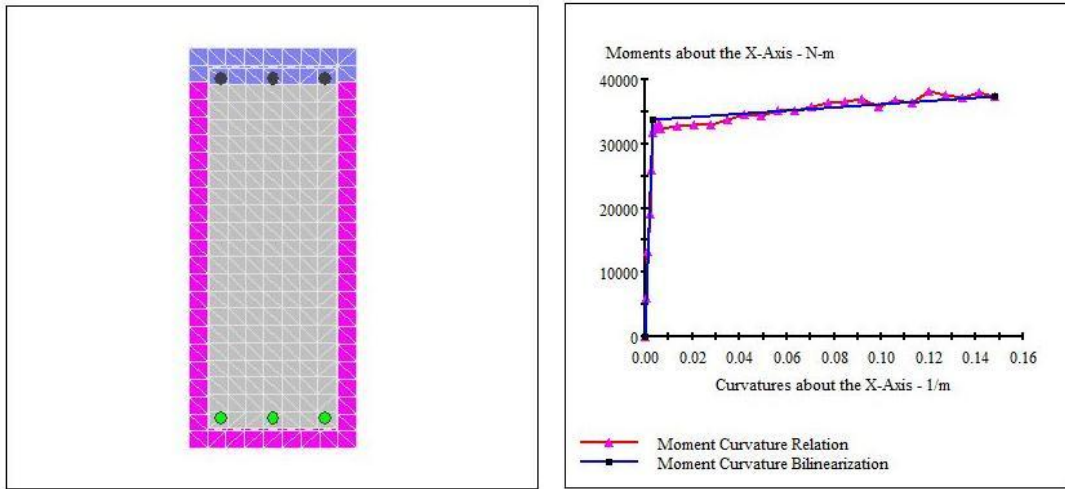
C14 beton sınıfı için sargılı beton modeli, [53]
